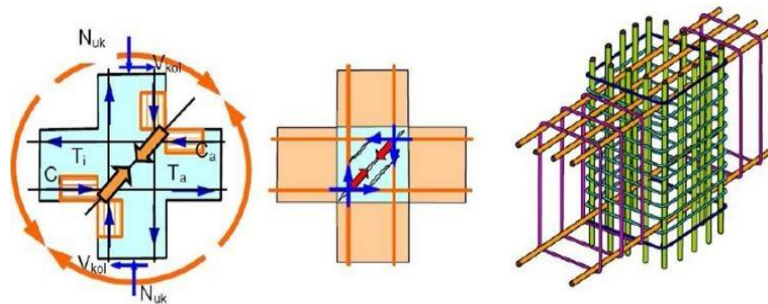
Geometris Sambungan Balok Kolom Interior
